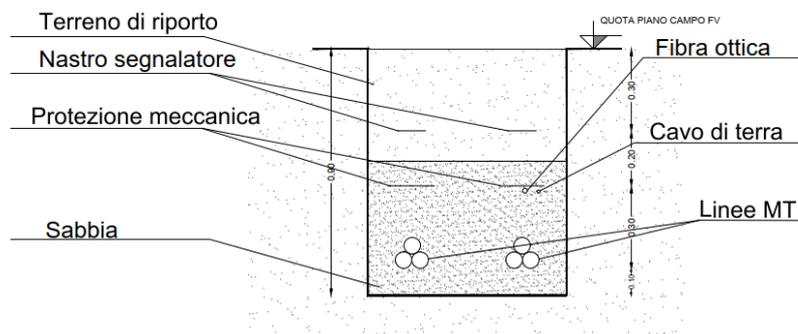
Sezione cavidotto MT interrato a singola terna di cavi (Sez. A-A) - estratto tav. GRE.EEC.D.25.IT.P.15533.00.047
